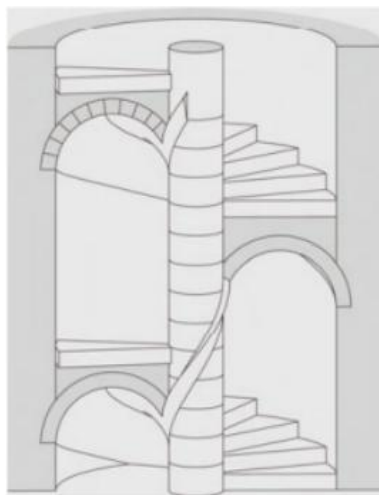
escalier en vis sur voute rampante en berceau torique.
